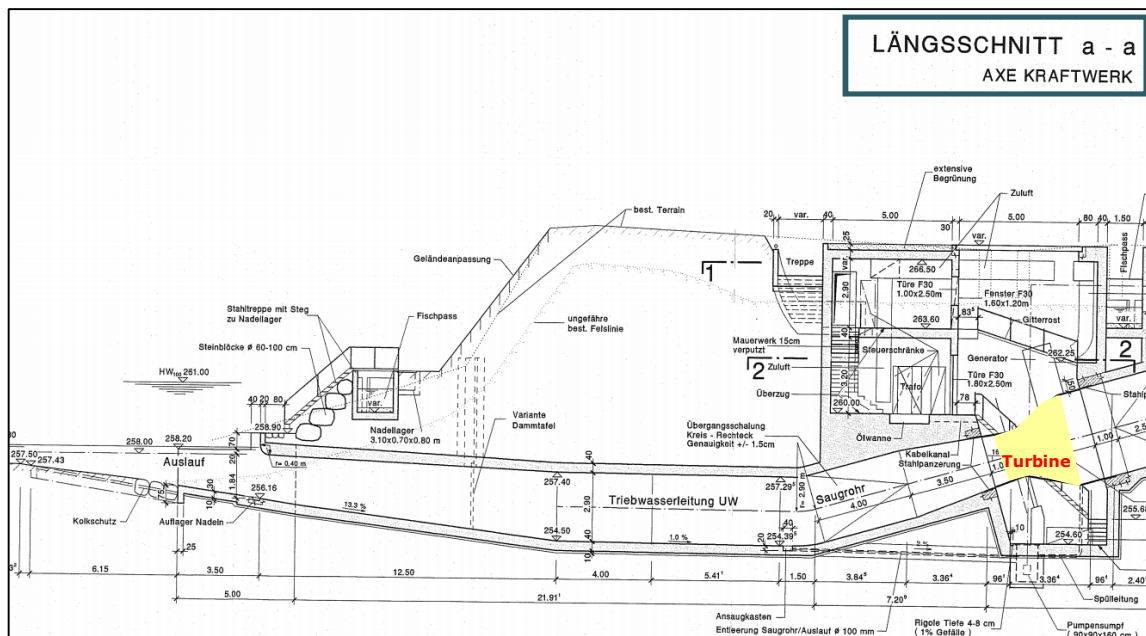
Auszug Längsschnitt, Auslauf Turbine mit Schnitt durch die besth. Fischtreppe (Längsschnitt a-a)
